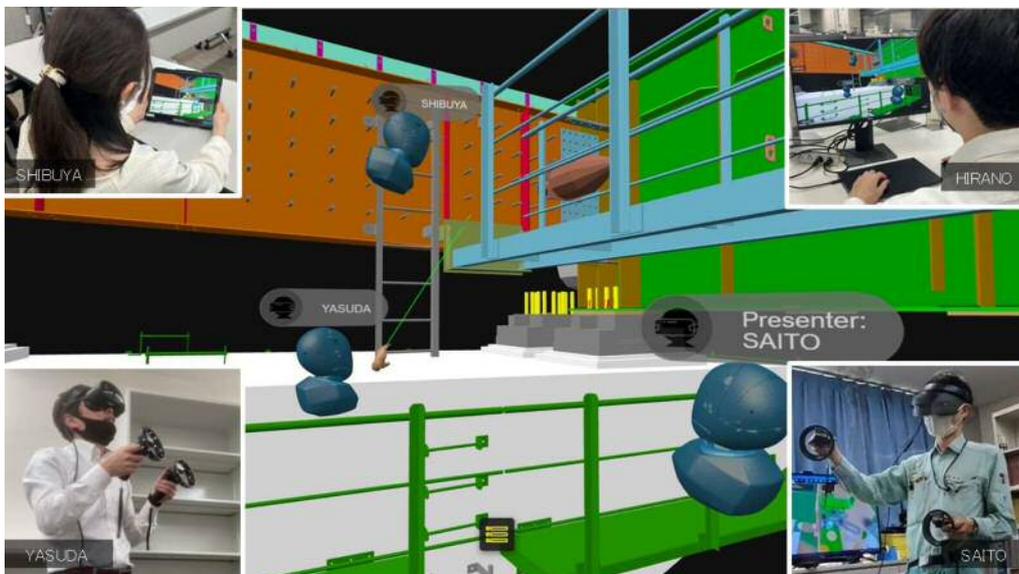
鋼橋 BIM/CIM モデルを連携させた 3D 構造検討
